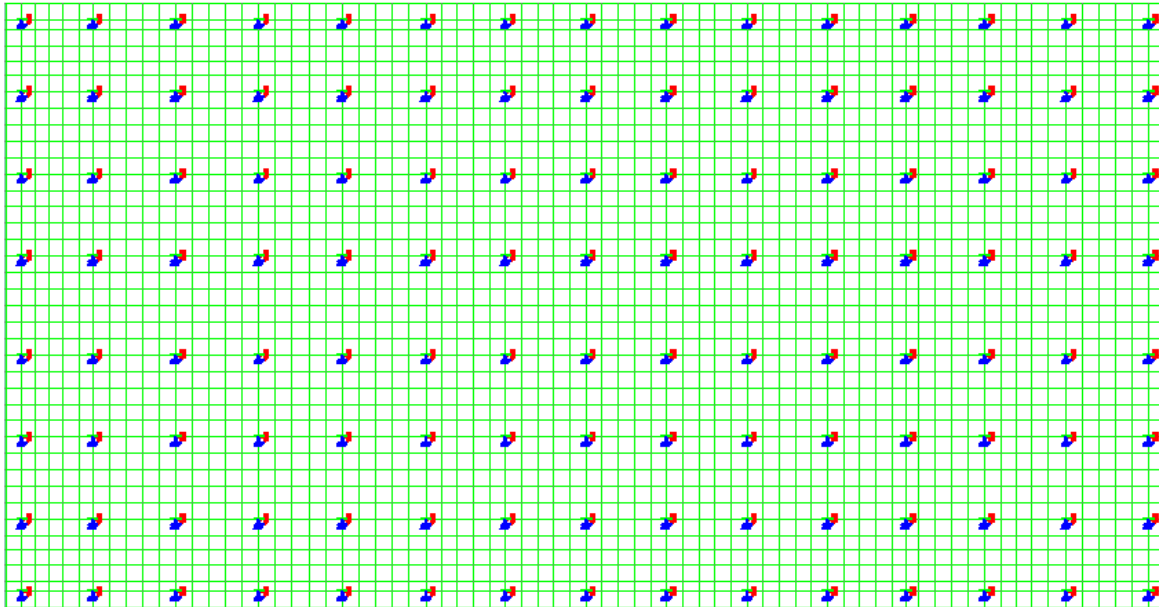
Planimetria pali e platea di fondazione sul modello di calcolo STAAD
